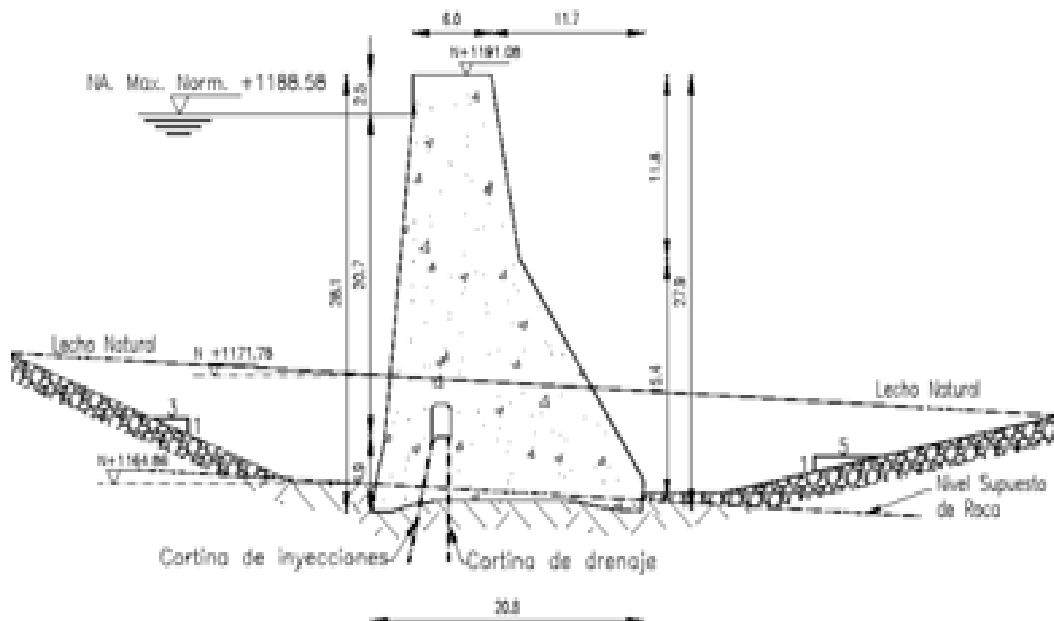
3 Sección Transversal Presa Santa Cruz Corte (D-D)
